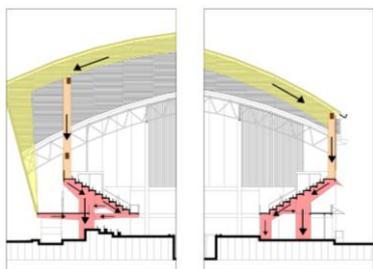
Detail tumpuan struktur atap dengan kolom secara vertikal dan horisontal
